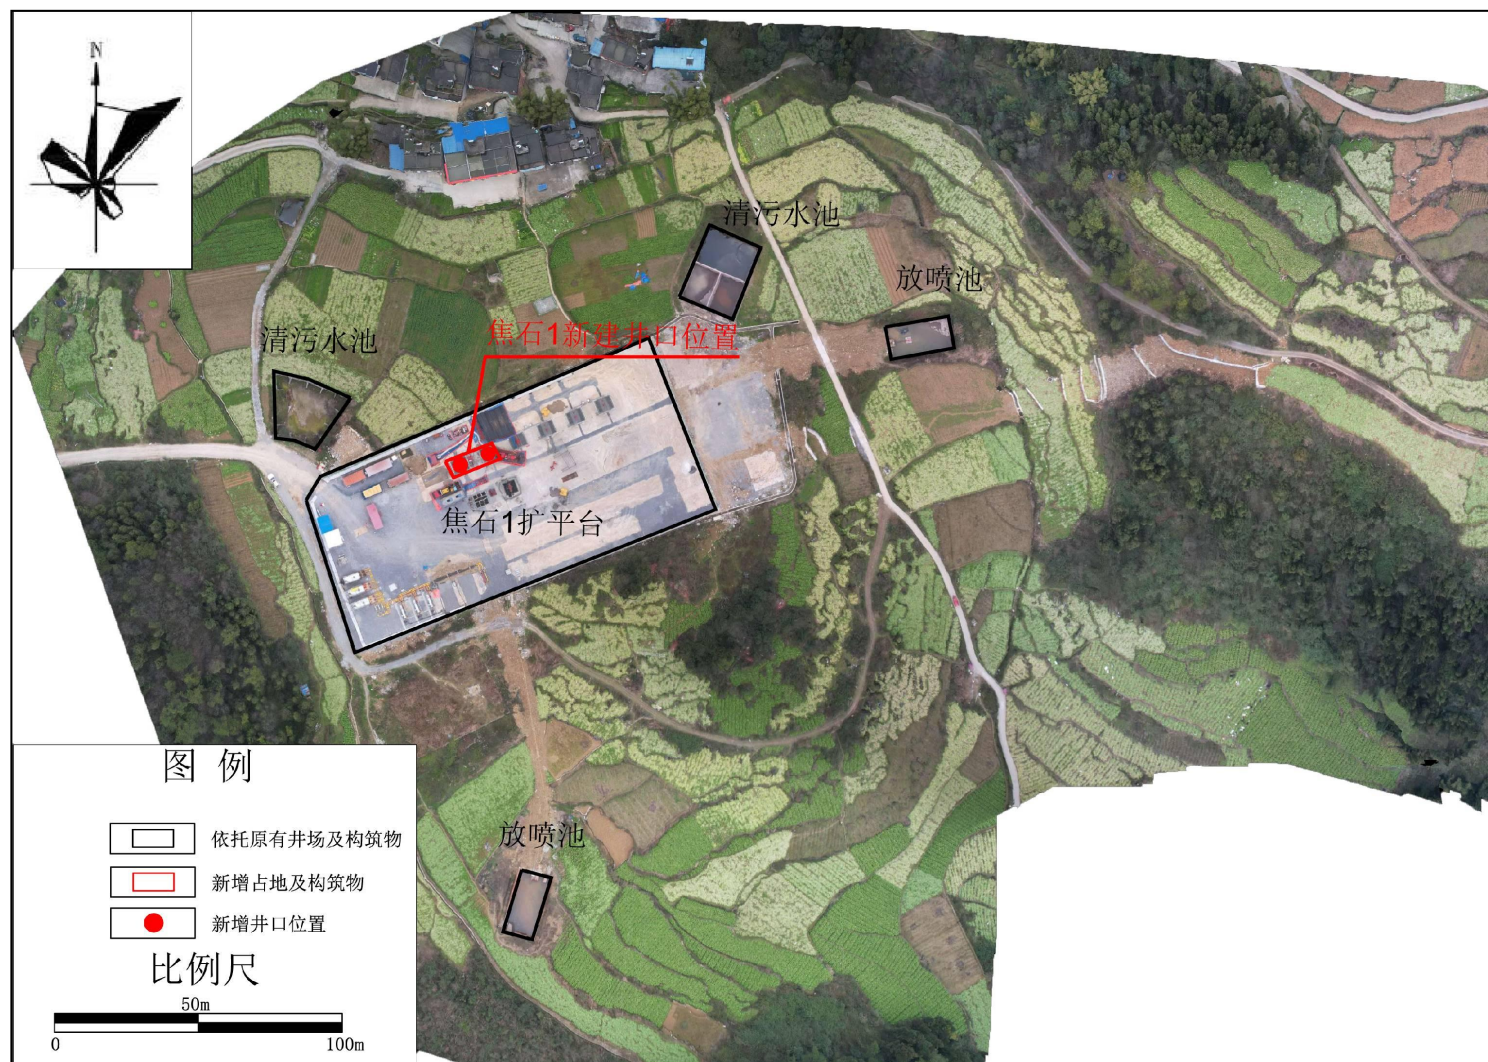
焦石 1 扩平台及焦页 1 集气站平面布置图
